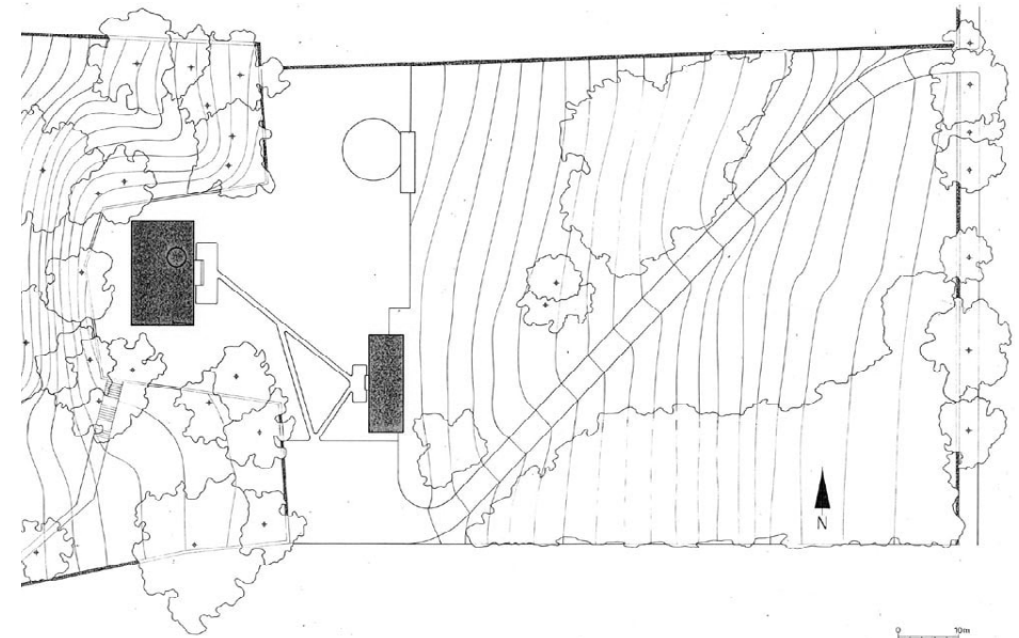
Philip Johnson, Glass House (links) und Brick House (rechts), Connecticut, 1949, Lageplan
